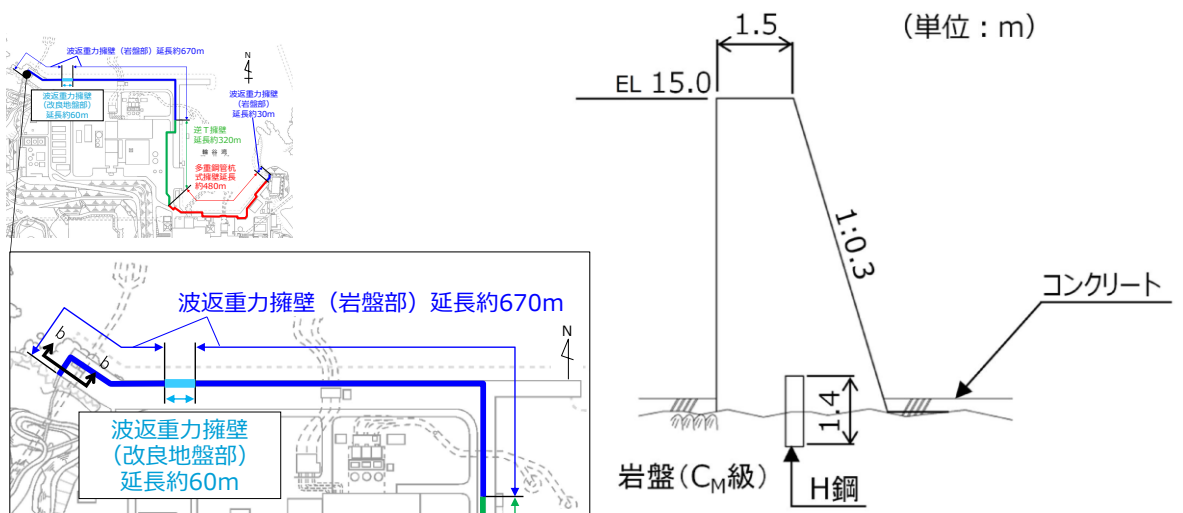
防波壁 (波返重力擁壁) 西端部 (b-b 断面) 断面図
